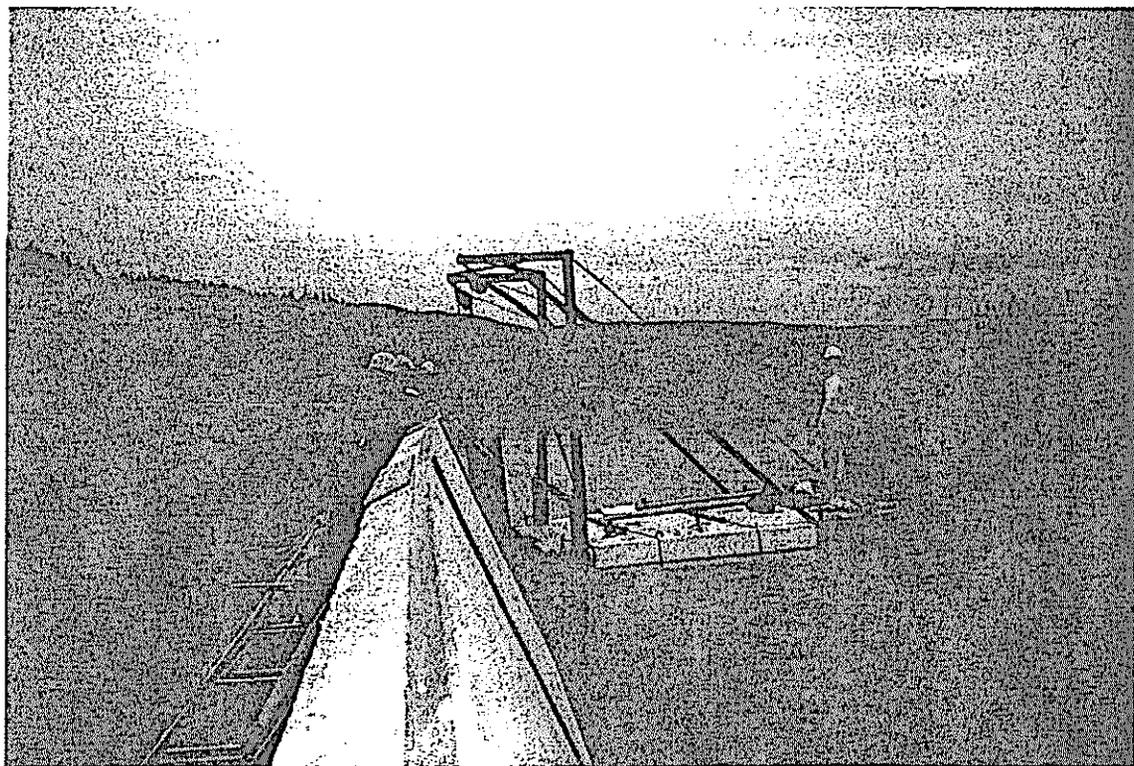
Installation des éléments de rehausse sur le barrage
